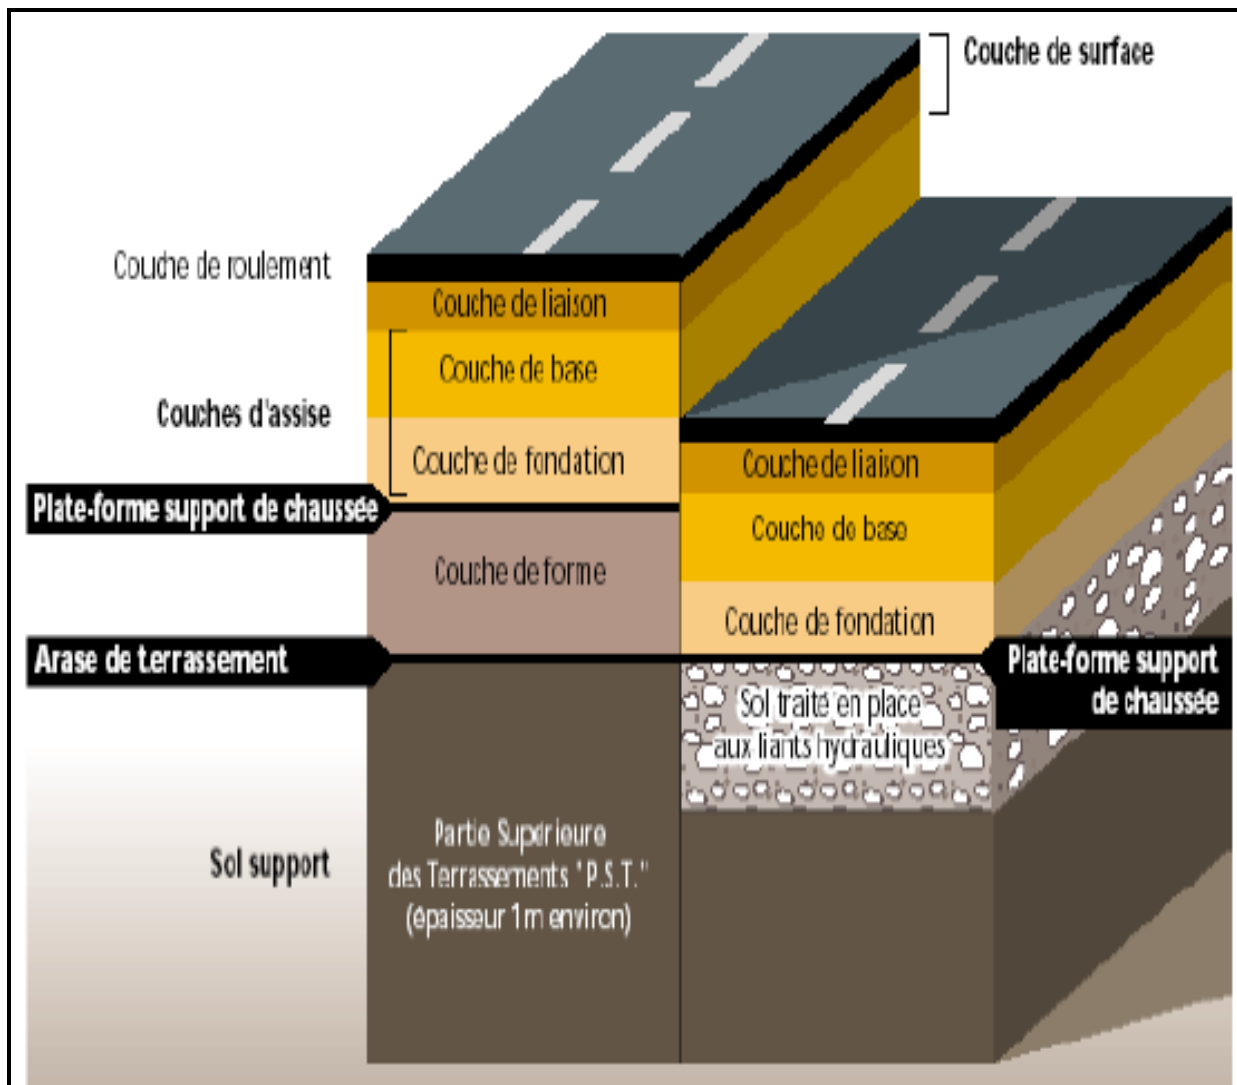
Différentes Couches Constituant La Structure De La Chaussée. [17]
